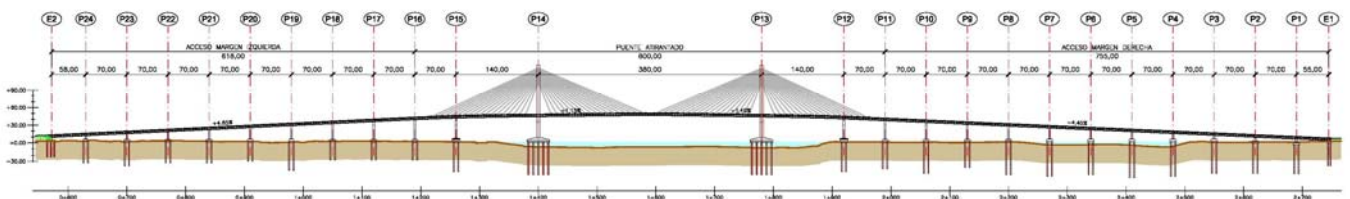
Alzado general de la estructura del Nuevo Puente de Pumarejo
